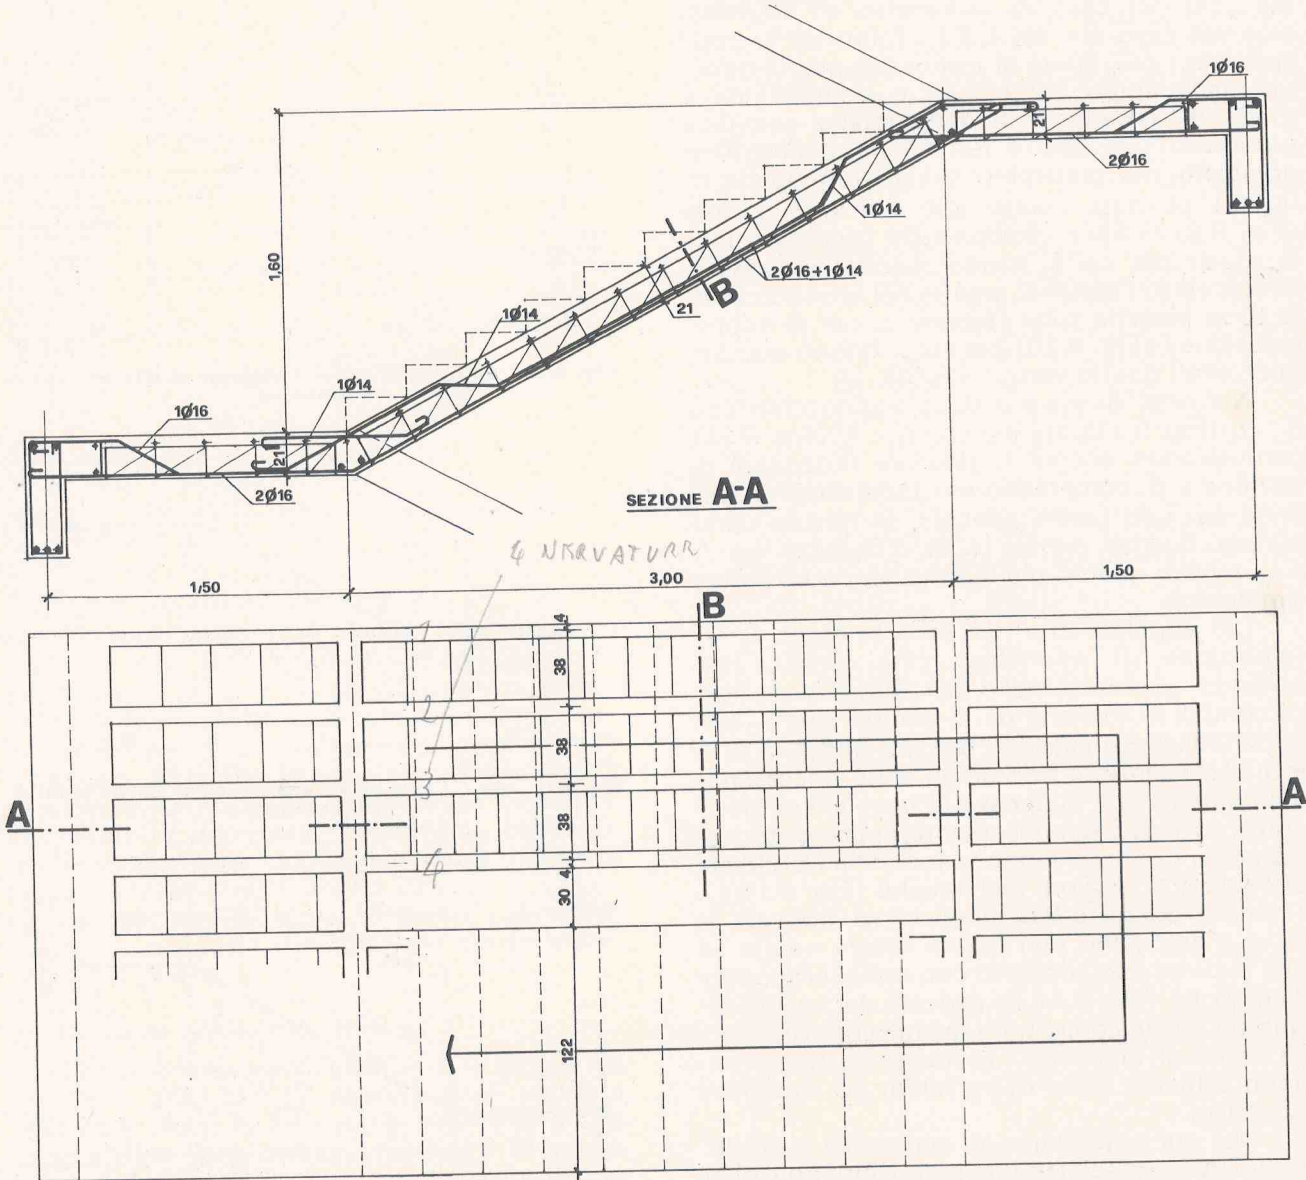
Particolare esecutivo di una rampa di scala a doppio ginocchio con solaio misto in cemento armato e laterizio.
